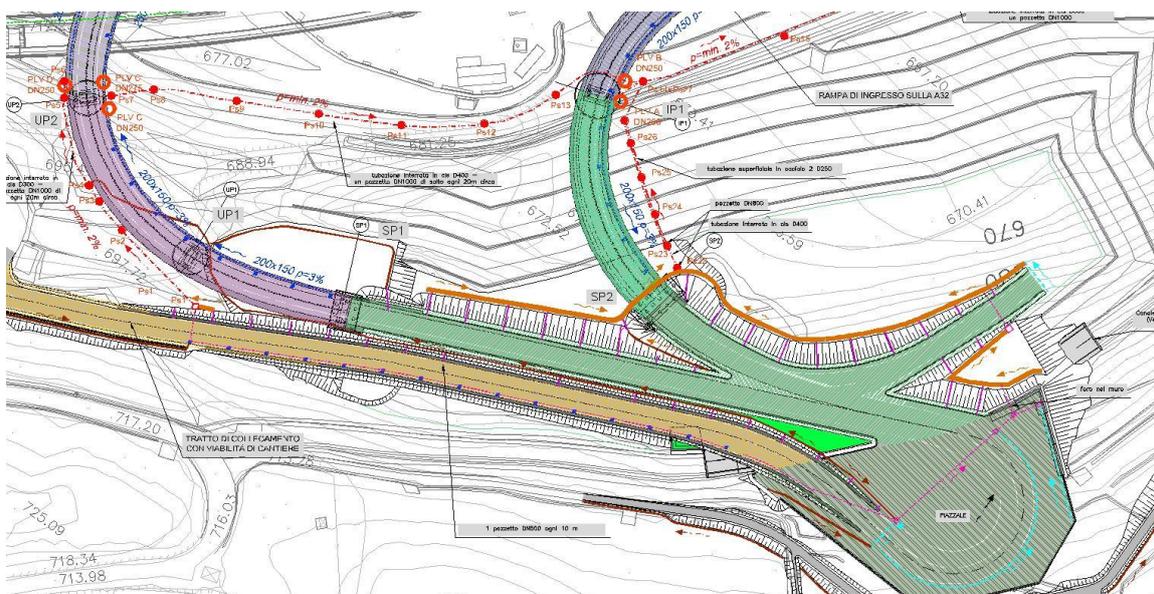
tratto di collegamento viabilità di cantiere e innesti delle rampe (tav. PE. ID_1200)
